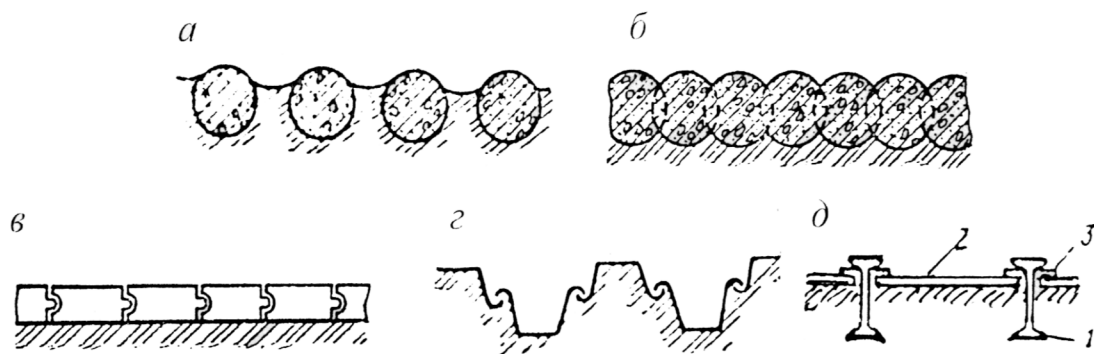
Огороджувальні конструкції стін (котлованів):
